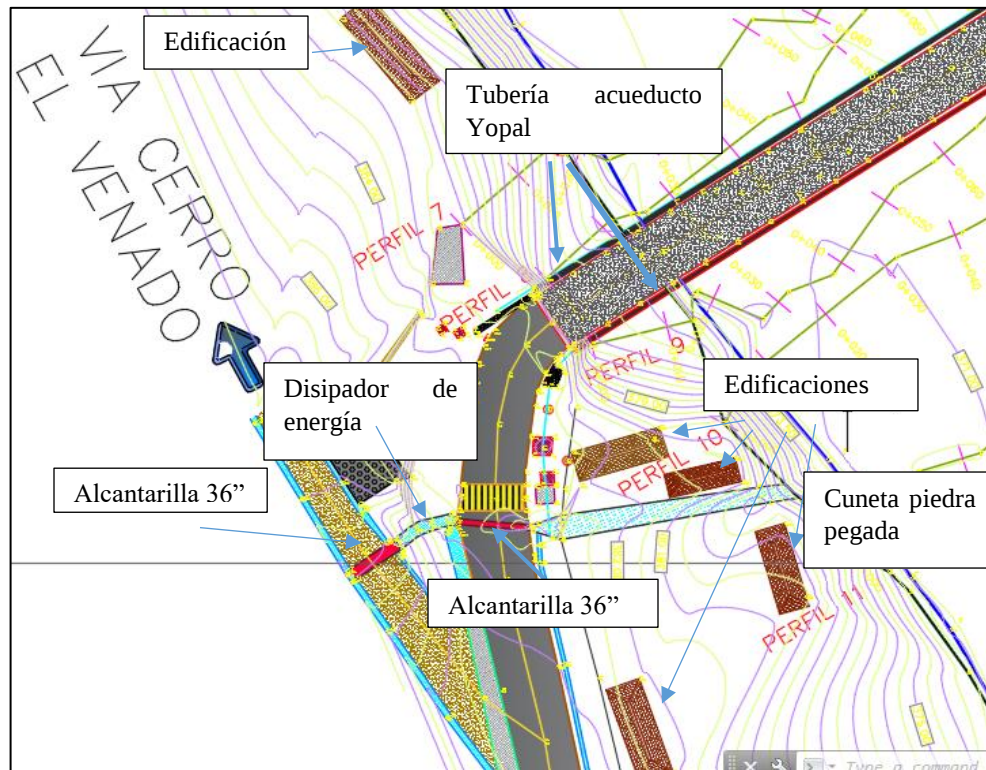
Vista en planta edificaciones ubicadas en la zona occidental del puente, lado Yopal. Fuente: levantamiento topográfico Consorcio IPV.
